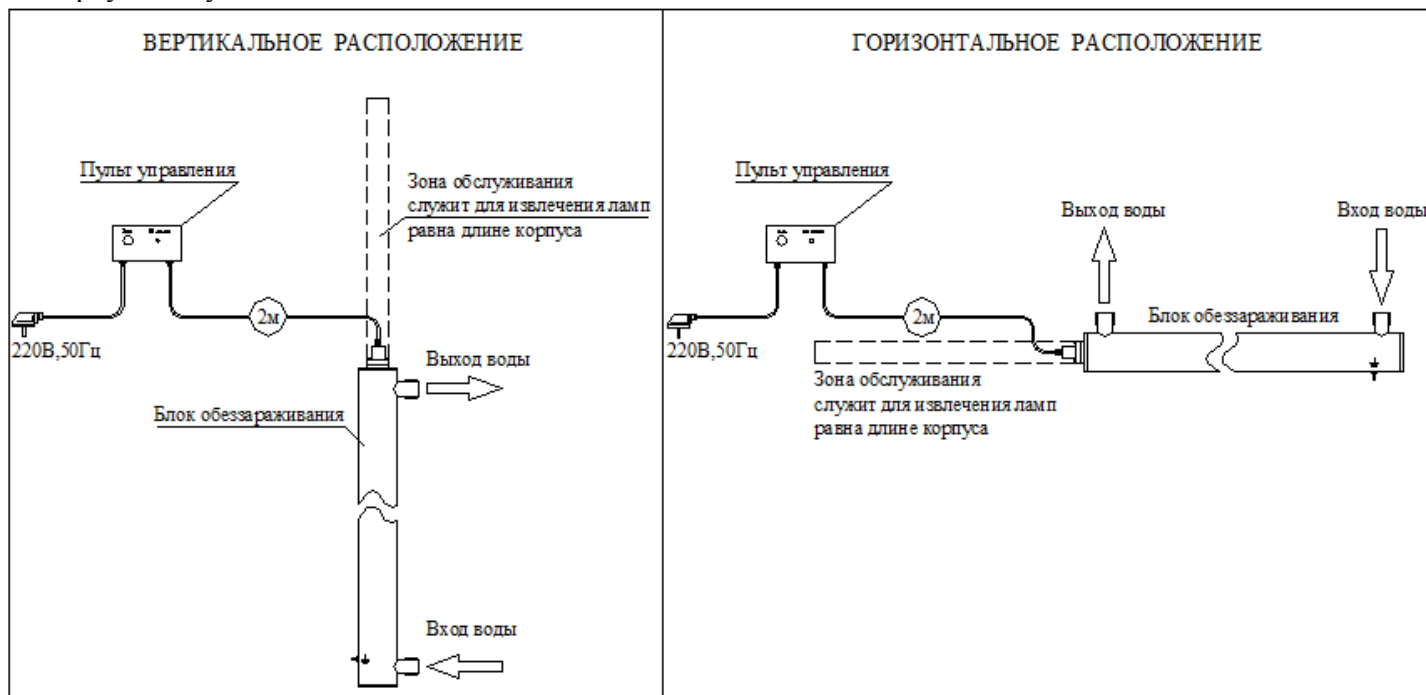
Общий вид установки типа «ОДВ» расположение установки
